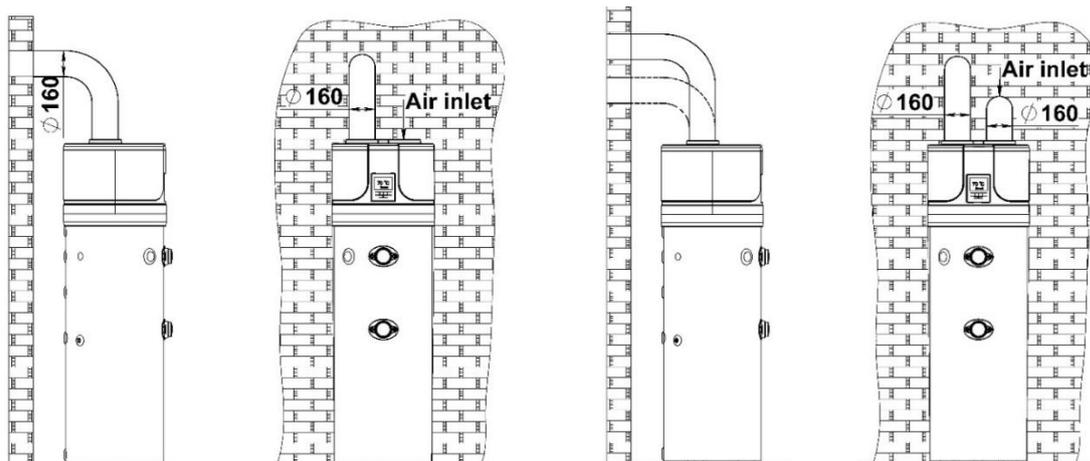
Exemple de conduit d'échappement d'air Fig. 5b – Exemple de double conduit d'air
